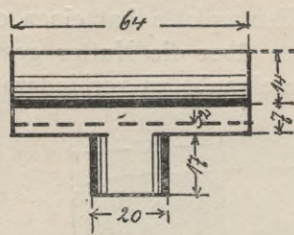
zeigt den Schnitt und Grundriss einer gusseisernen Unterlagsplatte.
